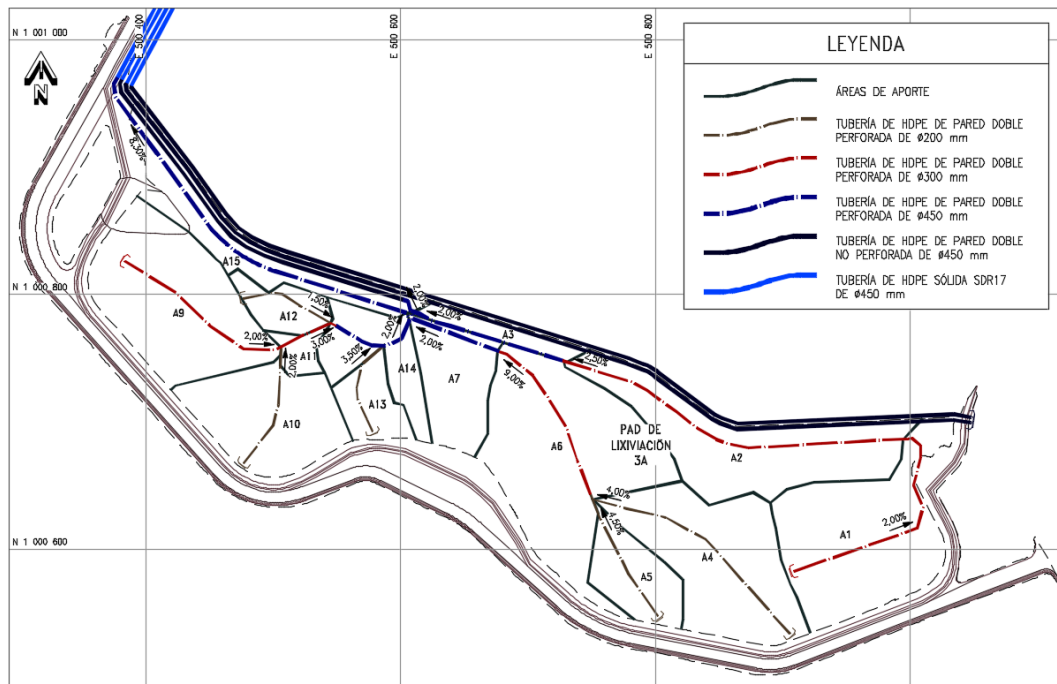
Vista en planta de la configuración del sistema de colección
